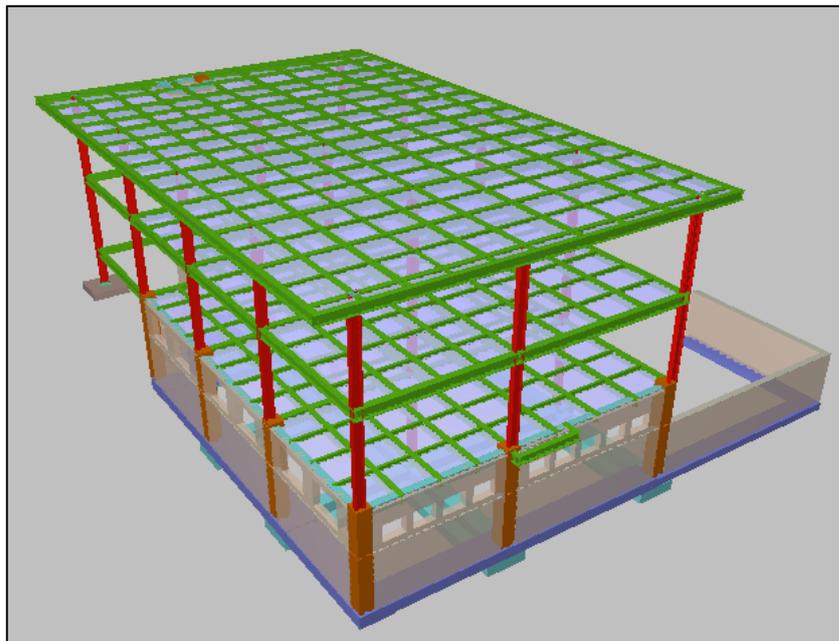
Modelo en Acero Estructural (lado derecho)
